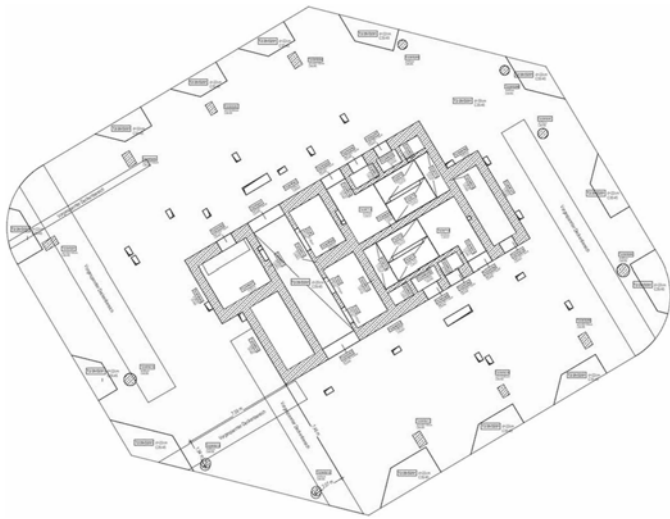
Grundriss Kern Regelgeschoss T2 (Quelle: ATW FOUR)
